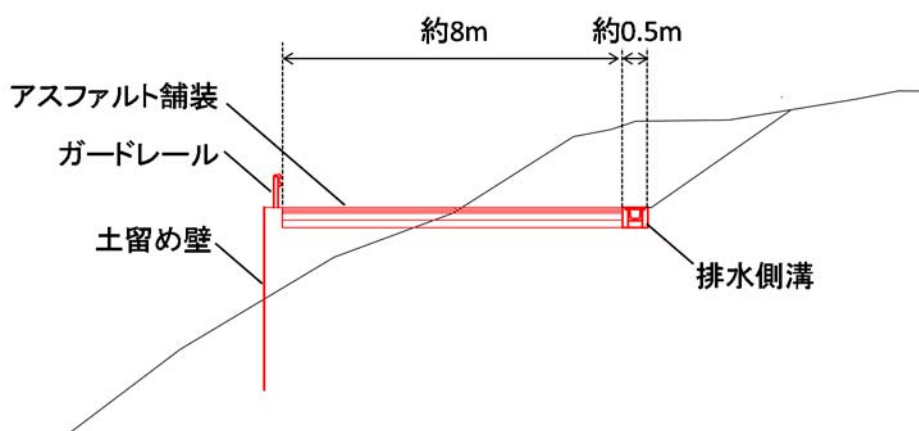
(10) 北側工事用道路（土工区間）の標準断面図
